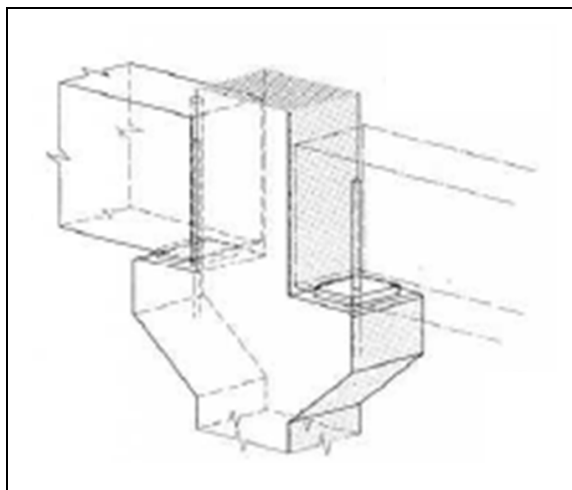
Ligação por consola curta de betão com ferrolho (Stupré, 1981)
